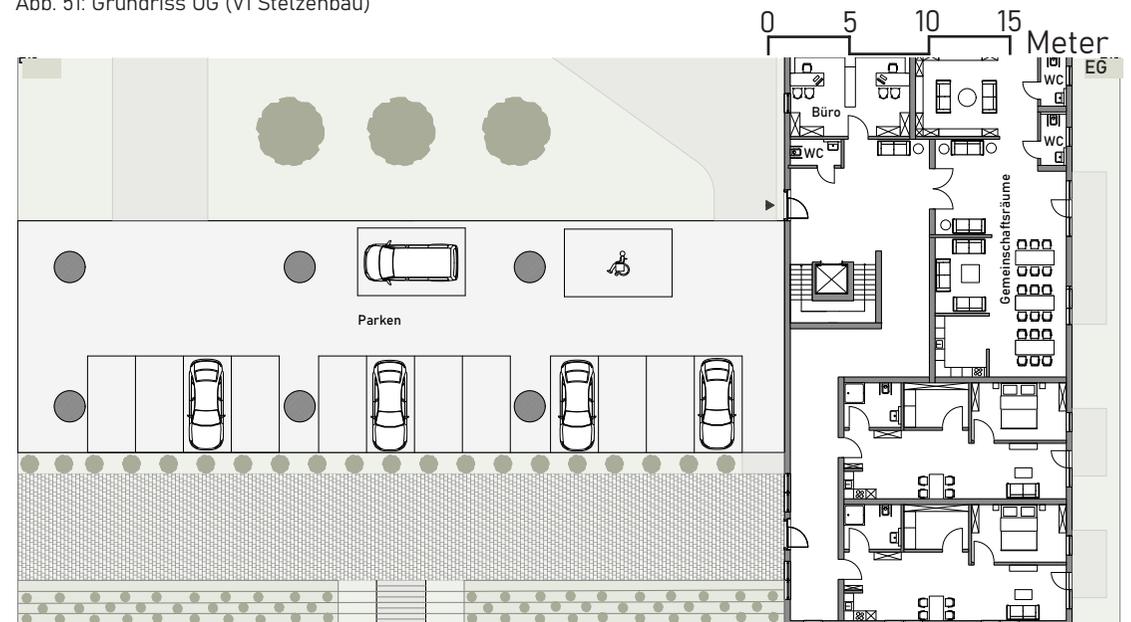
Grundriss EG (V1 Stelzenbau)
